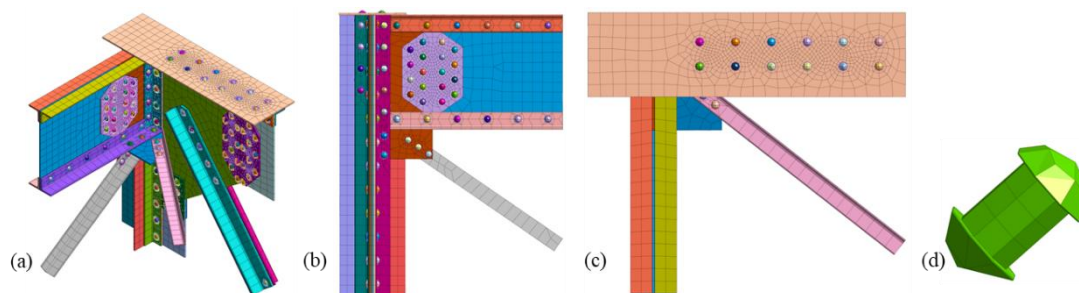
Modello locale appartenente alla campata isostatica meshato con elementi solidi; (a) vista prospettica; (b) vista YZ; (c) vista XY in pianta; (d) dettaglio del rivetto con teste emisferiche.
